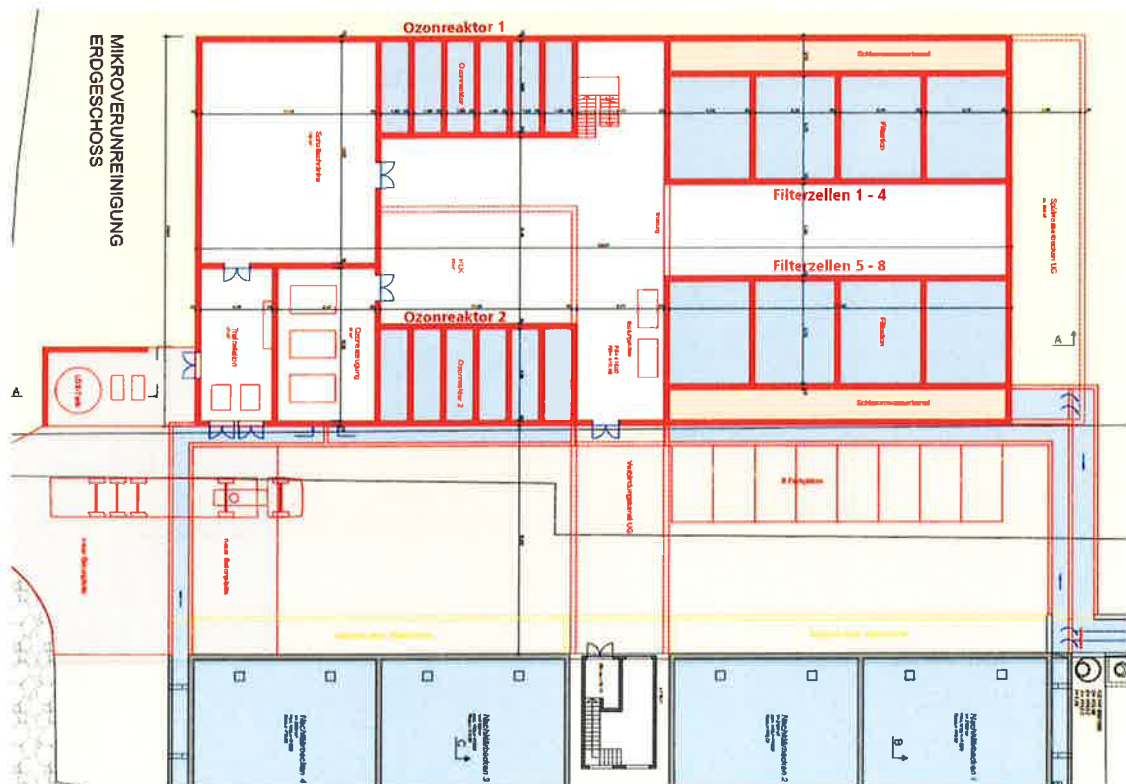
Grundriss des Erdgeschosses der MV-Anlage.
